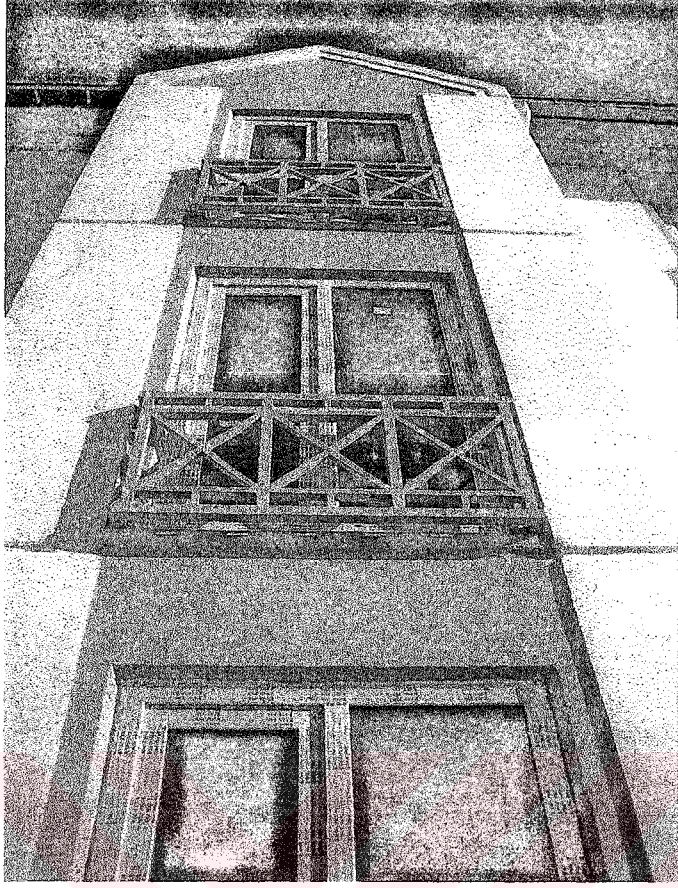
Cephe boyası bitmiş bir K4-1 blok görünüşü
